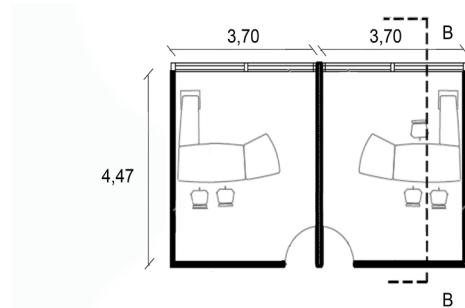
Planta tipo de dos oficinas de tipología arquitectónica cerrada (OC). Medidas en metros. Fuente: Elaboración de las autoras.
